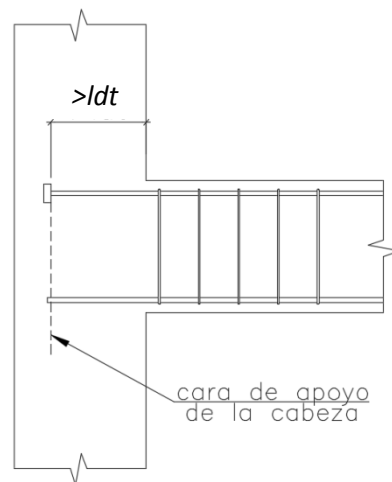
Anclaje de barras corrugadas con cabeza
